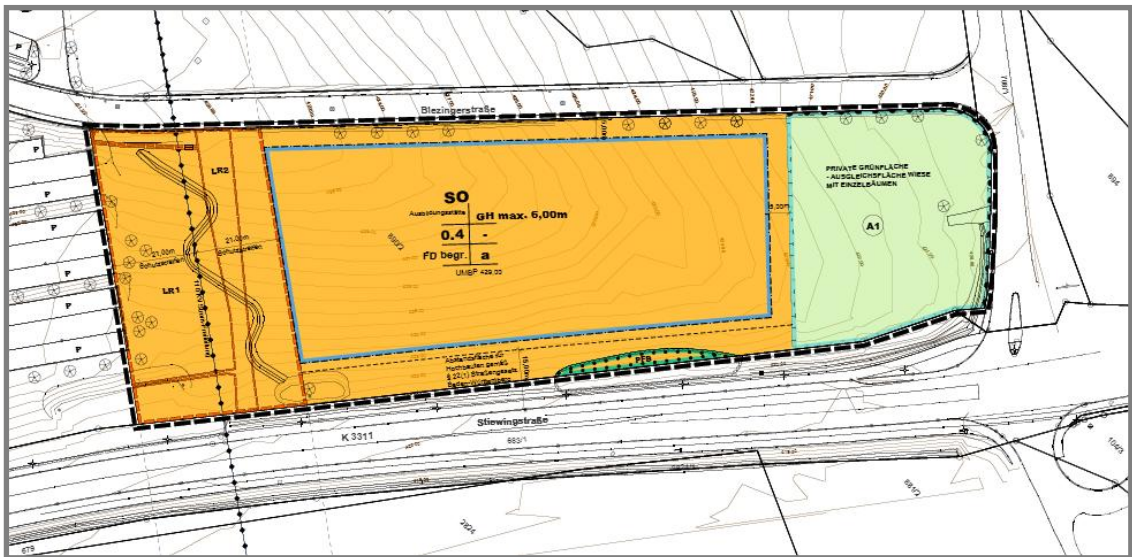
Bebauungsplan „Zwischen Stiewingstraße und Blezingerstraße“, Plan Nr. 78-03 (unmaßstäblich)
